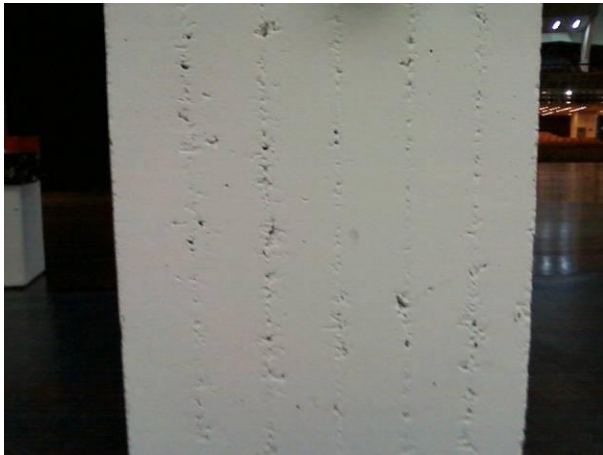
Segregação superficial do concreto na direção das barras de aço do pilar P11H – face C.
